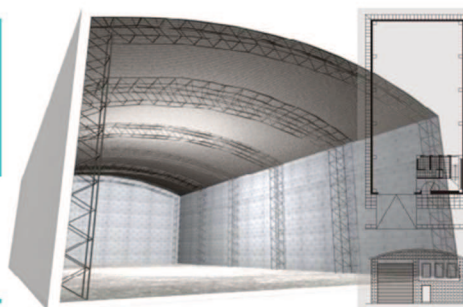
Plano de distribución en planta. Fuente: Elaboración propia.
